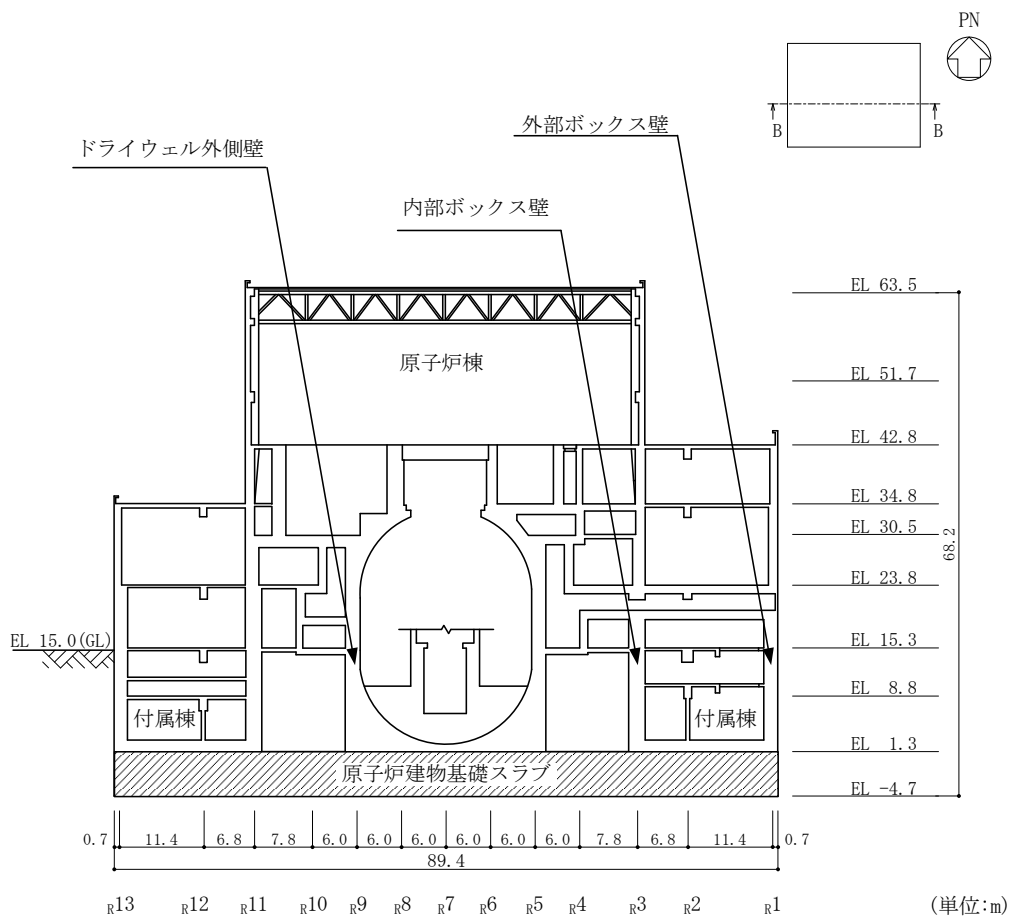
(2) 原子炉建物基礎スラブの概略断面図 (B-B 断面, EW 方向)
